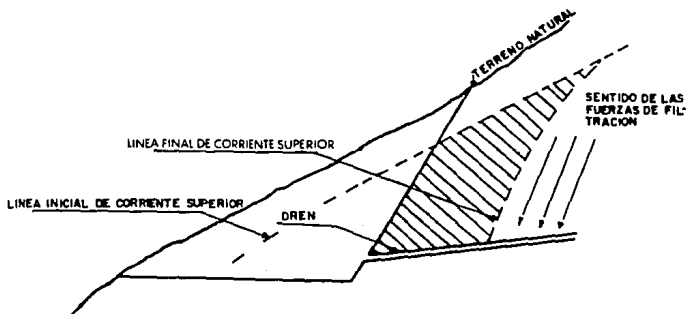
Forma en que un dren transversal de talud realiza la captación.
